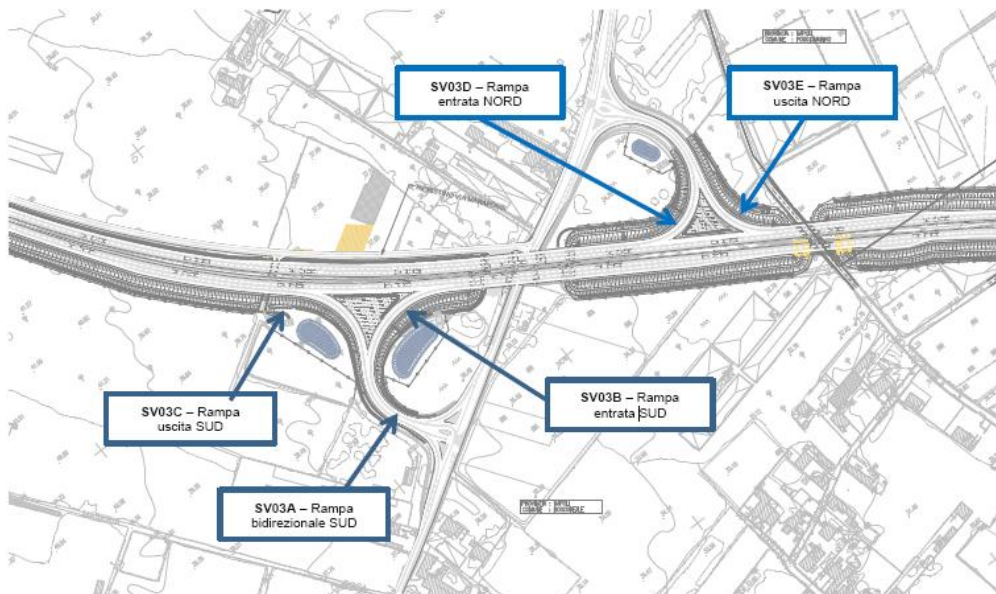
Stralcio Planimetrico dello Svincolo di Boscoreale - Poggiomarino
